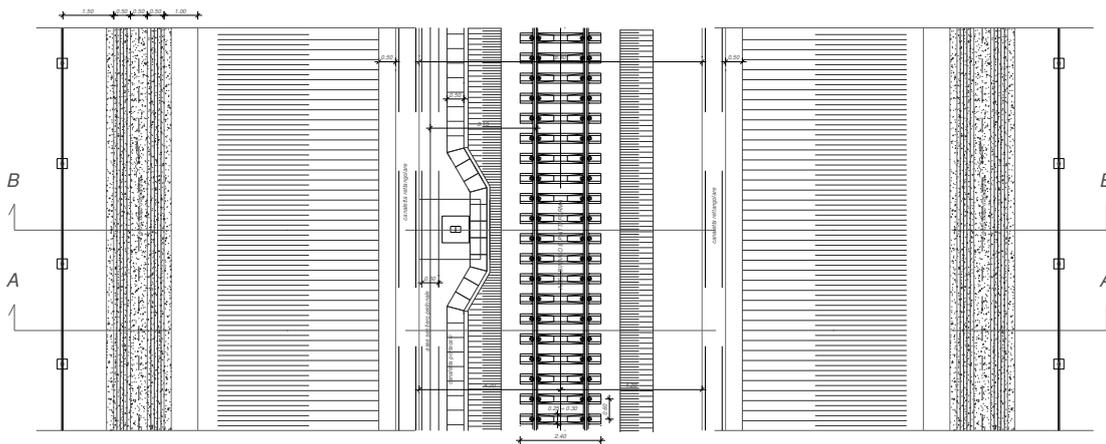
Stralcio planimetrico con sezione tipo ferroviaria in trincea a singolo binario in rettilineo
